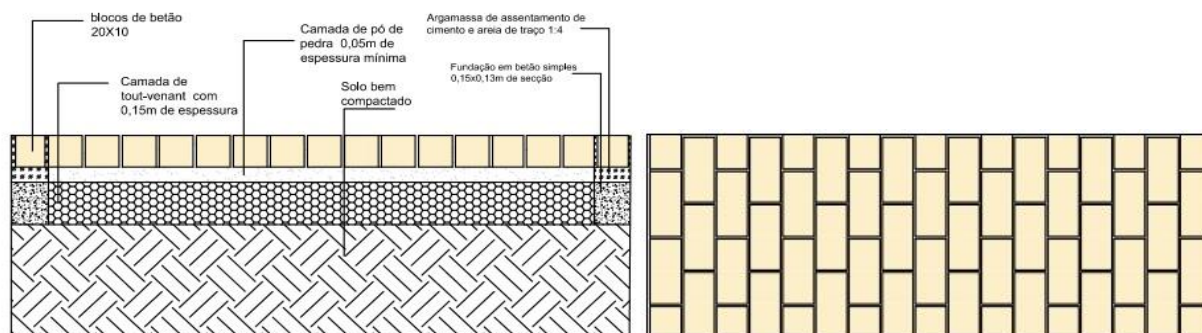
Proposta: Pormenores construtivos pavimento pavê
